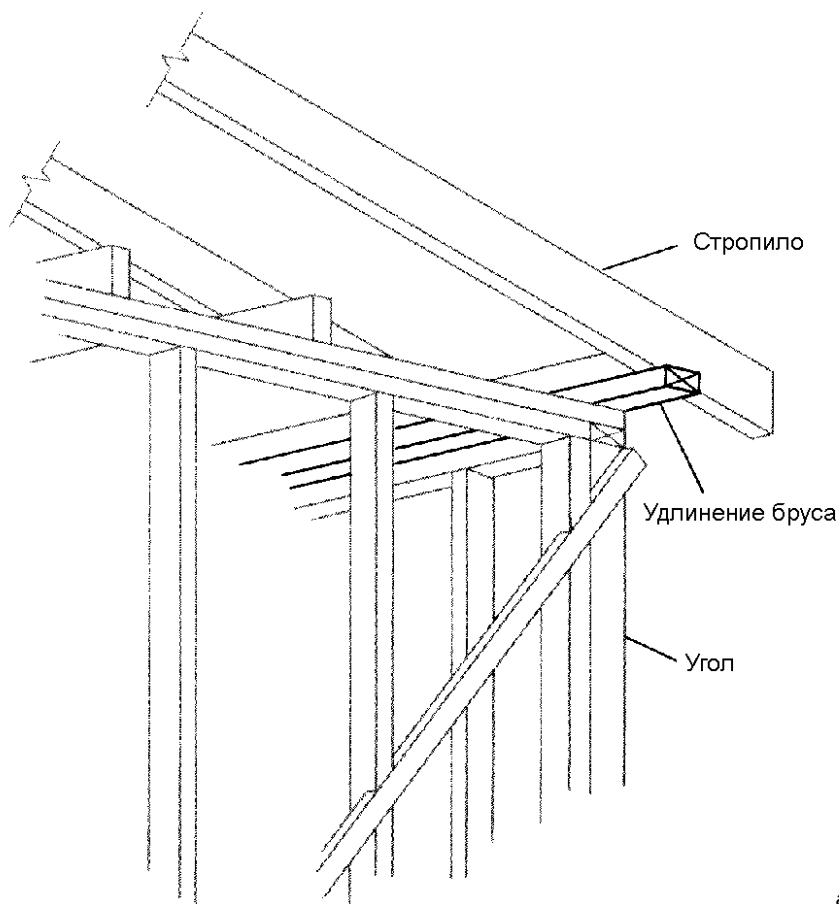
Создание рамной конструкции фронтонного свеса:
